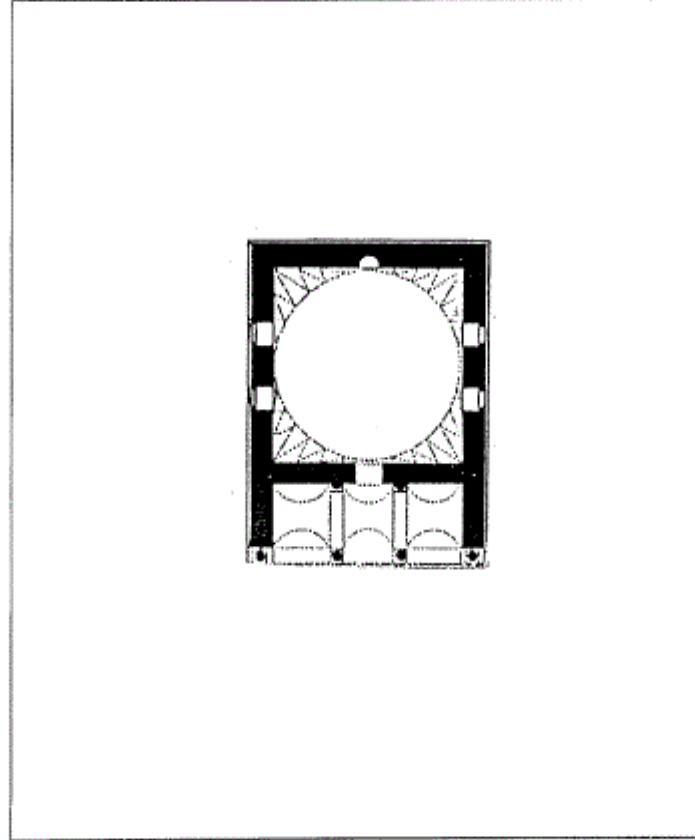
مسقط أفقي لمسجد حسن يالى زاده في الباسان (عن : كيل) .
